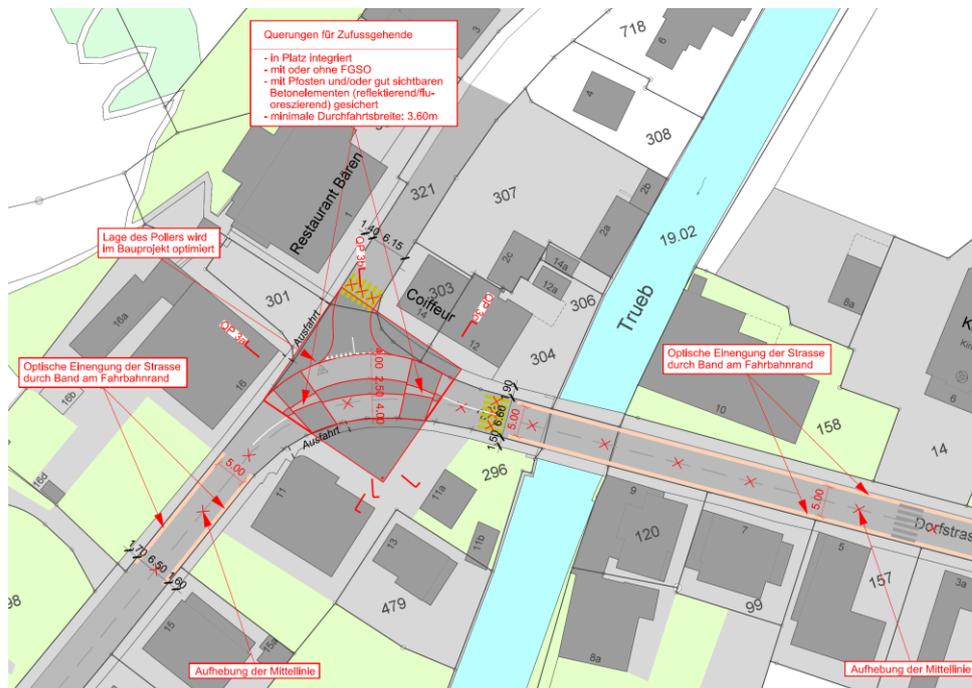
Ausschnitt Massnahmenplan Bärenplatz
